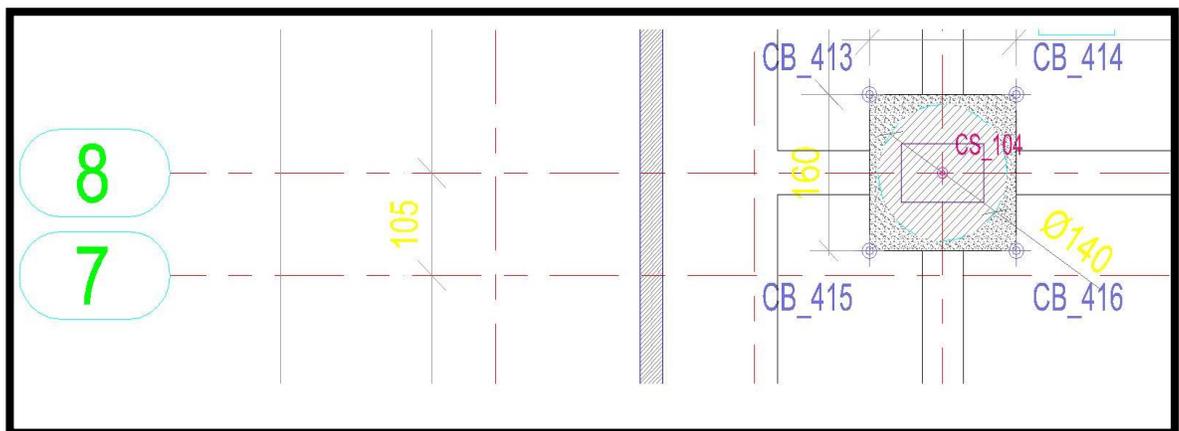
Detalle pilote 104. (Fuente: Plano de cimentación MEISA)
